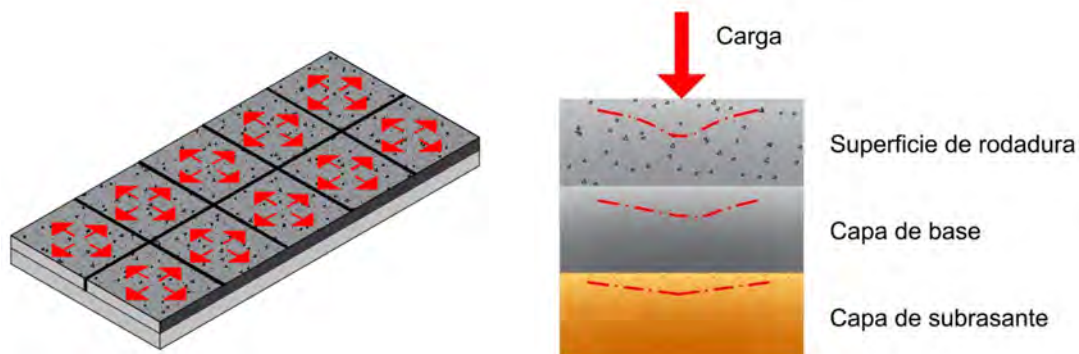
5 Transferencia de cargas sobre un pavimento rígido.
